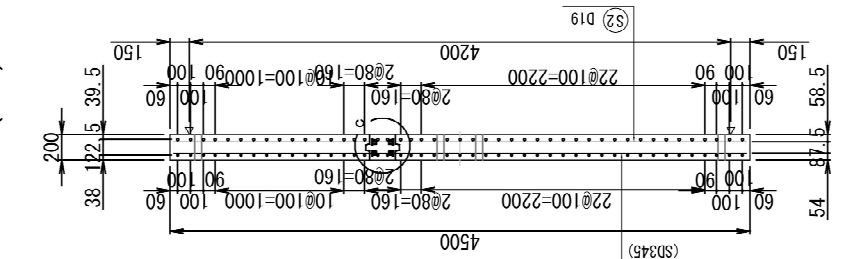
床版供試体 S2 の形状寸法 (単位 : mm)
